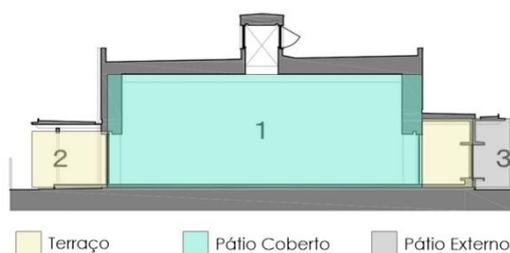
Planta Baixa - Ibarakai, Japão.
